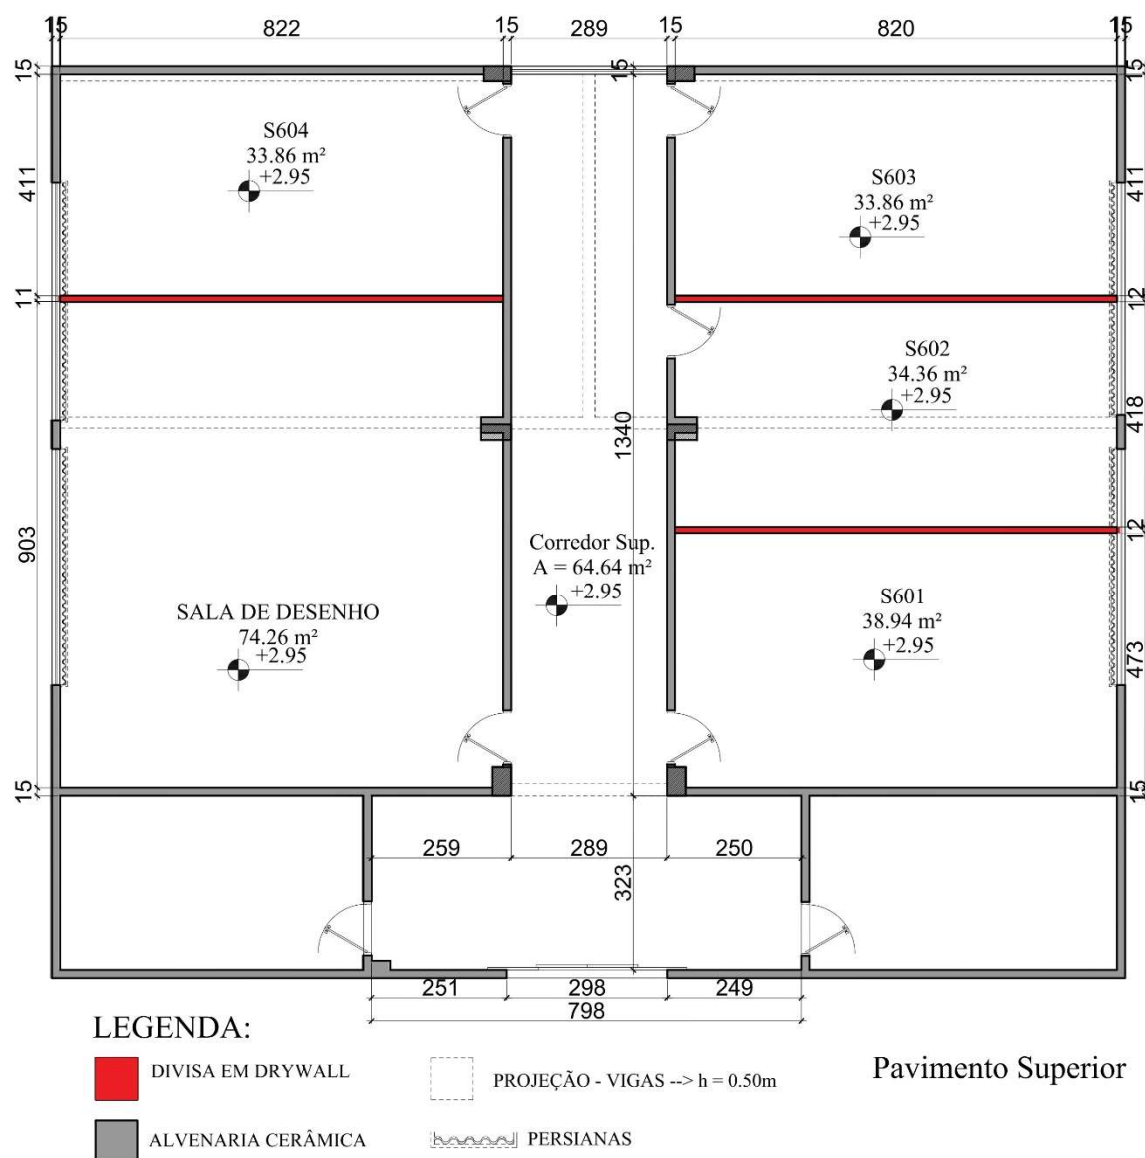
Planta de pavimento superior das salas a serem estudadas.
